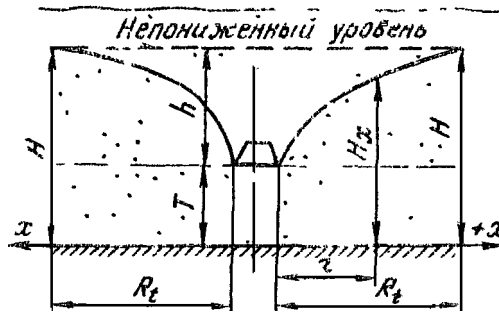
Схема к расчету длинной прямолинейной горизонтальной дрены, расположенной выше подошвы безнапорного водоносного пласта, с горизонтальной поверхностью естественных грунтовых вод
